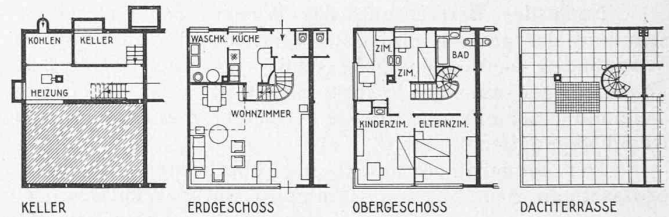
Grundrisse der linken Hälfte des Doppelhauses. — Masstab 1 : 400.
